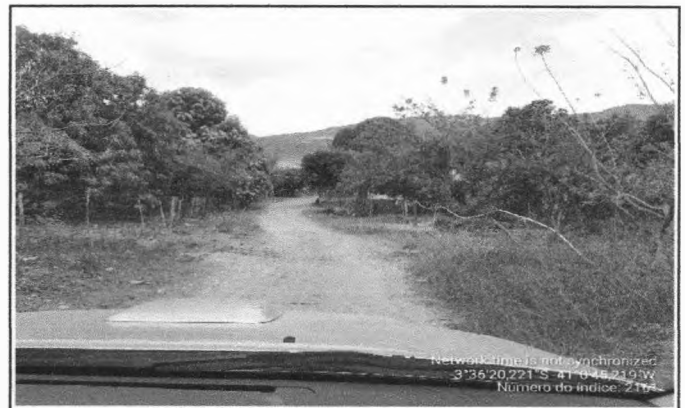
LOCAL DA CONSTRUÇÃO - BUEIRO TRIPLO TUBULAR
